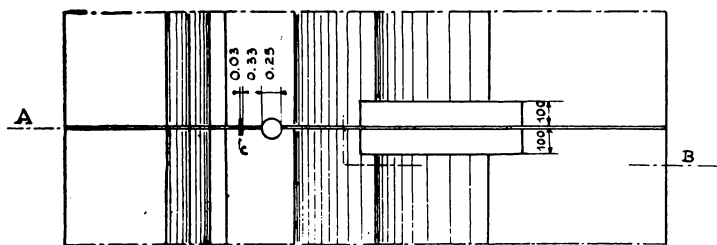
Etanchement du joint. (Coupe horizontale).
